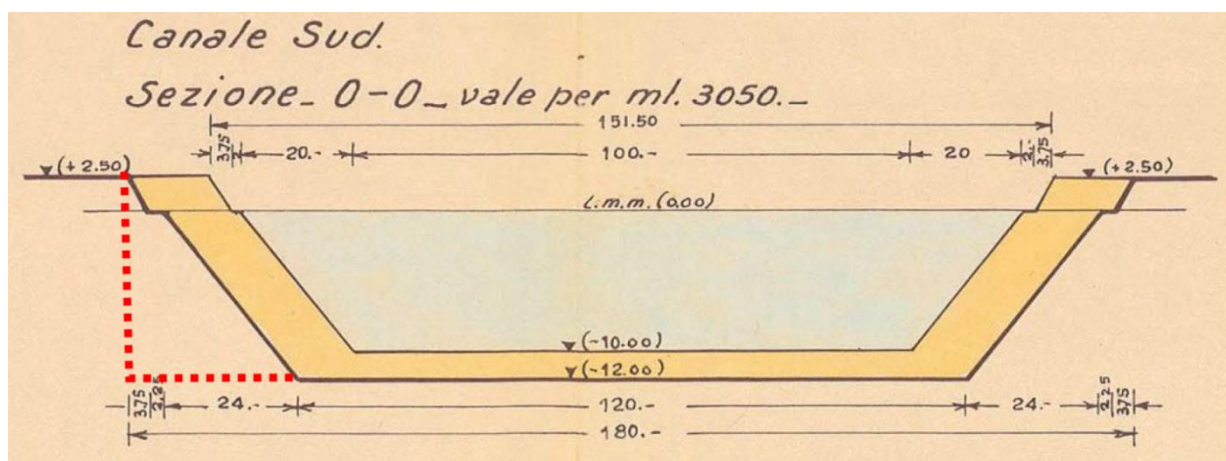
Estratto PRP 1965 – Sezione 0-0 con risagomatura cunetta di navigazione lato Sud filo banchina (in rosso tratteggiato la modifica)
